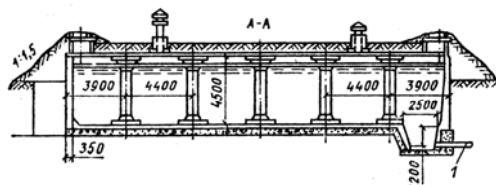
Конструкция резервуара цилиндрической формы:
